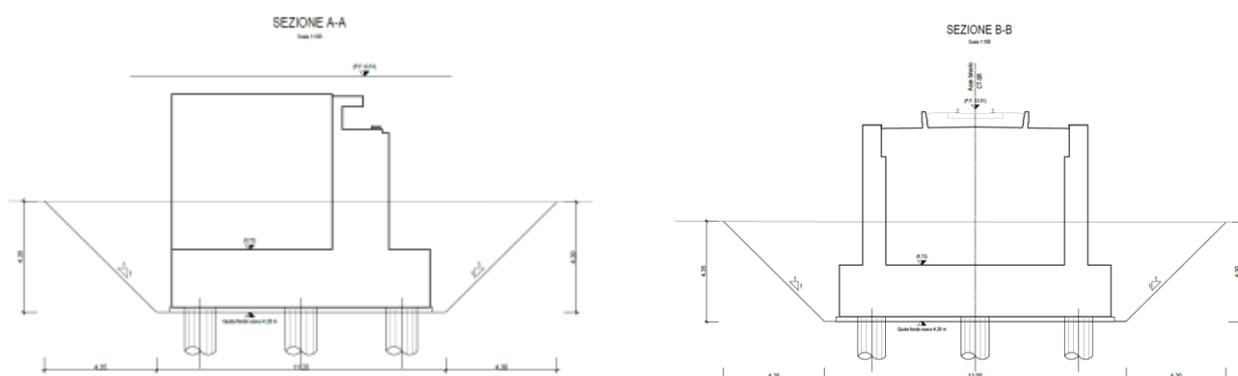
Sezione longitudinale spalla (sinistra) e Sezione trasversale della spalla (destra)
